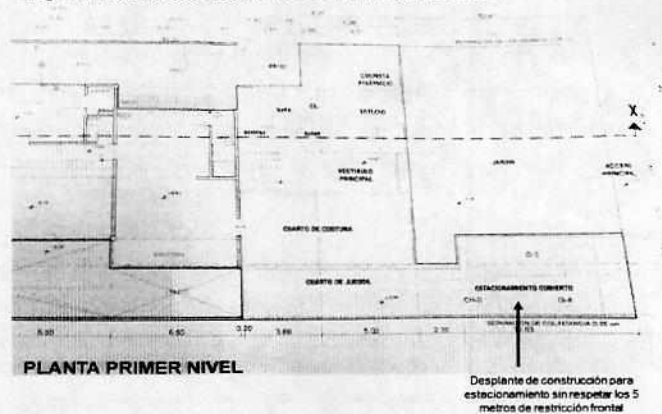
Plano arquitectónico con clave C-01 "Planta Baja, Primer Nivel"
